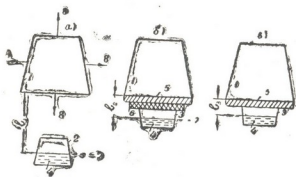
Схемы основных вариантов водоотвода: а — специальной выработкой; б — каналом с теплоизоляционным перекрытием; в — каналом с простым перекрытием; 1 — горная выработка со свежим воздушным потоком; 2 — специальная водоотводящая выработка; 3 — водоотводящий канал; 4 — горячая вода; 5 — несущее железобетонное перекрытие; 6 — теплоизоляционное перекрытие; 7 — условный уровень термальных вод; 8 — основные направления, вдоль которых строится распределение температуры в массиве
